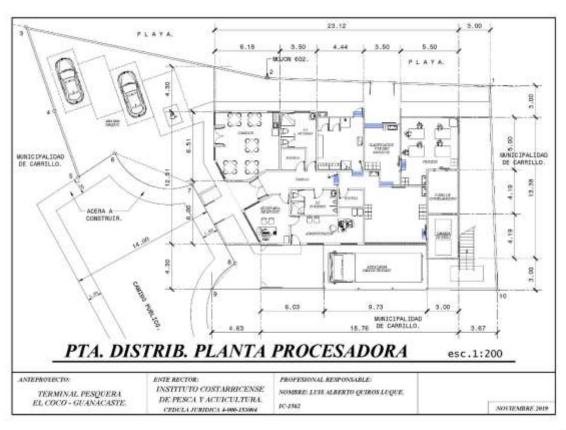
Planta de distribución de Planta Procesadora Fuente: Luis Alberto Quirós Luque DZA
